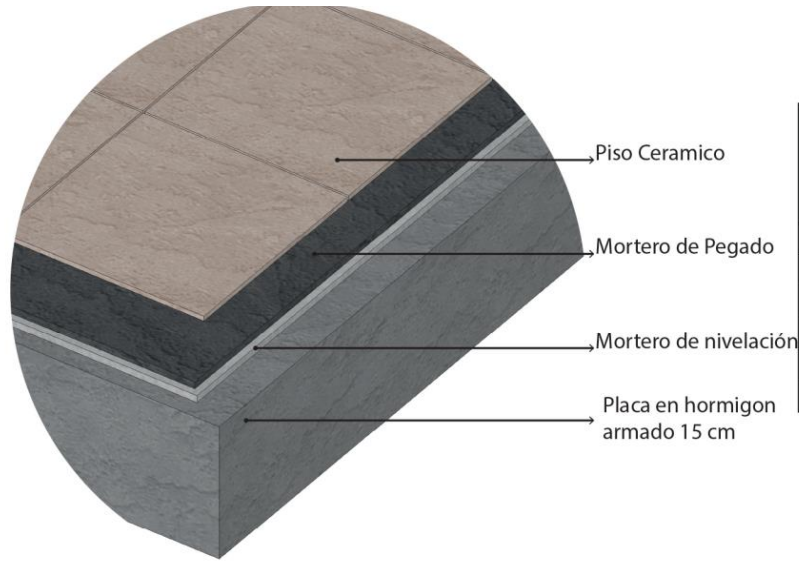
Detalle constructivo típico de una placa de entepiso típica maciza en concreto Fuente: elaboración propia
